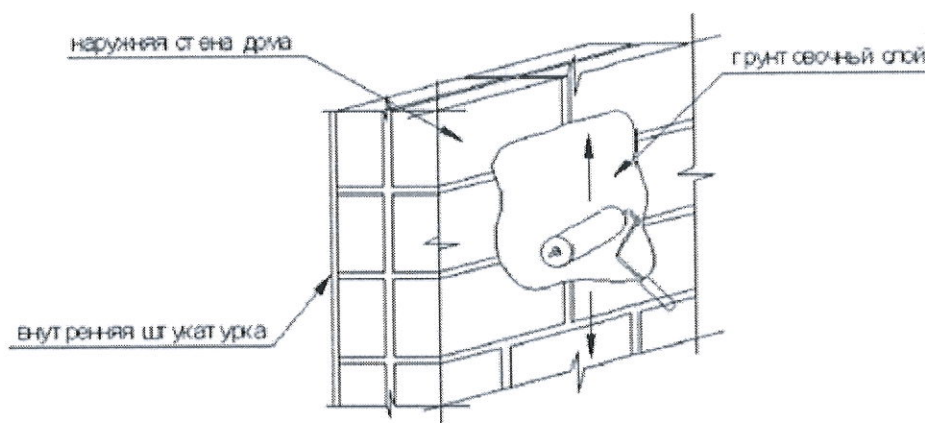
Нанесение грунтовки на наружную поверхность стены
